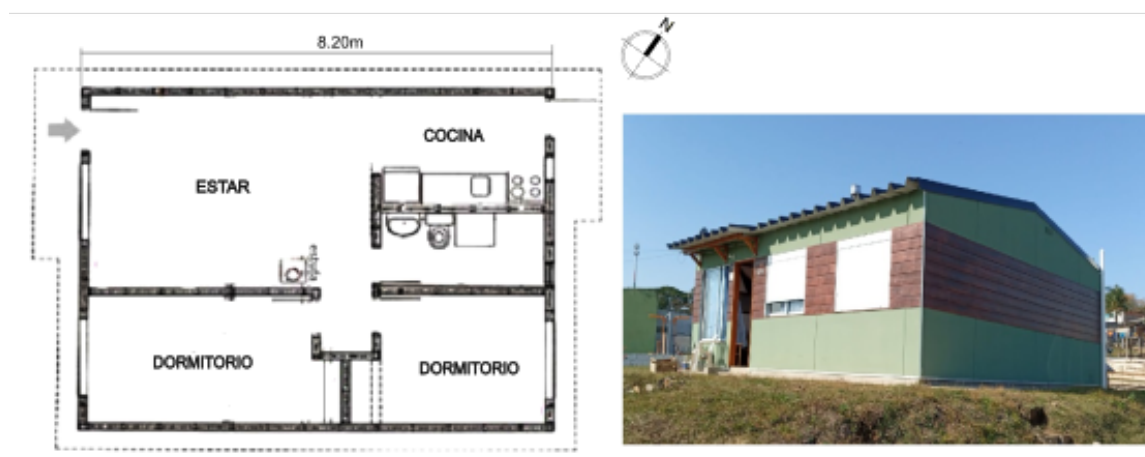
Planta e imagen viviendas monitoreada en Rivera
